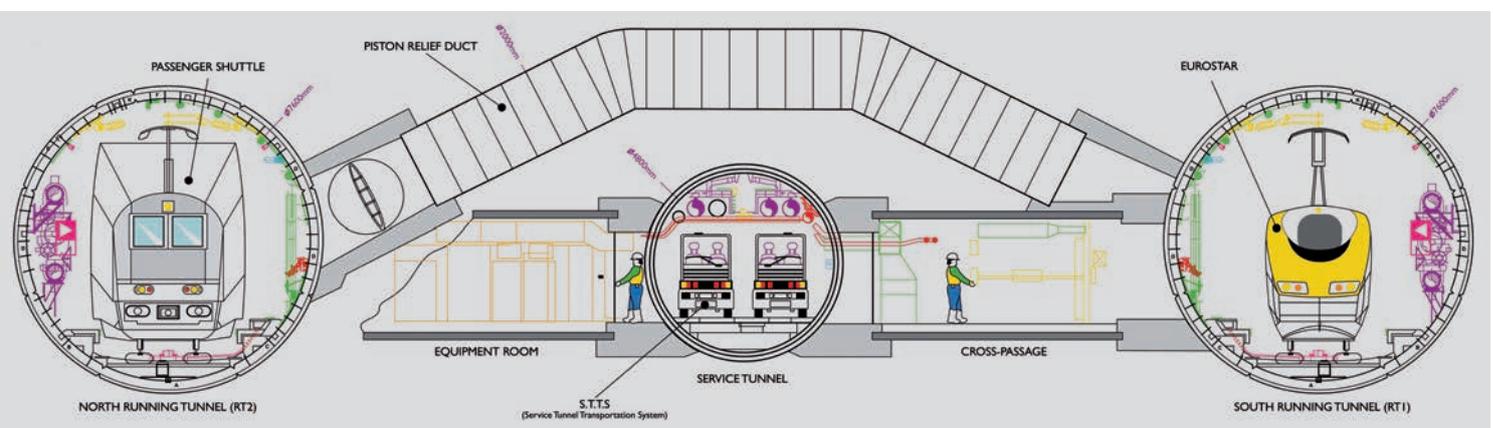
System des Eurotunnels (Frankreich/UK) mit mittigem Servicetunnel, Querschlägen (alle 375 m) und Druckausgleichsverbindungen
